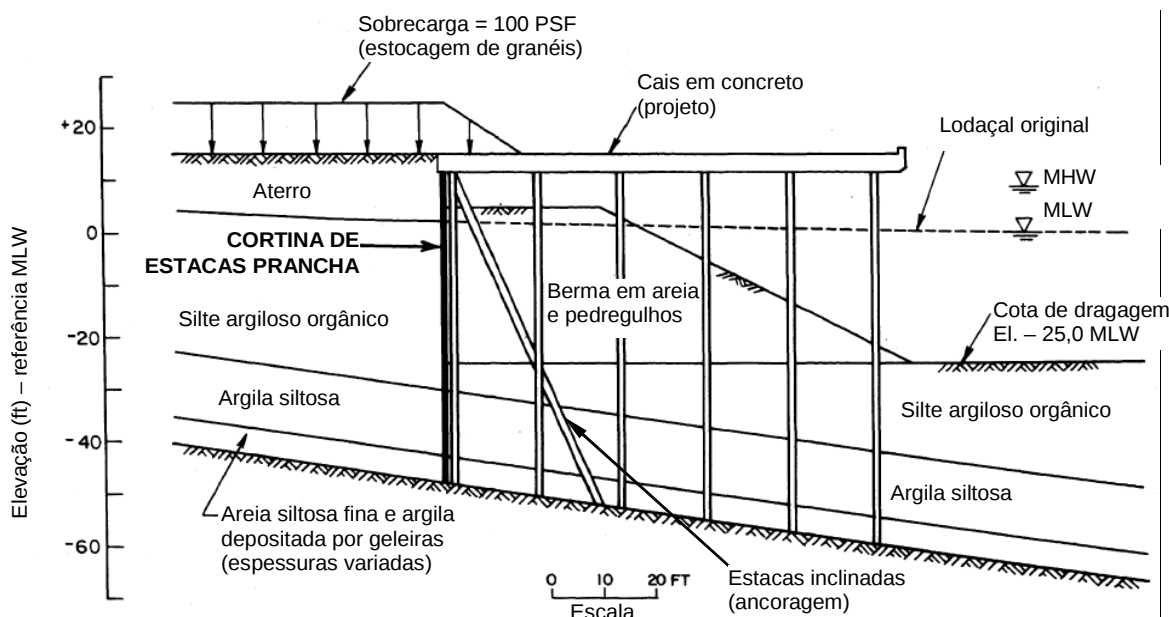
Corte transversal do cais - adaptado de LaGatta e Shields (1984)
